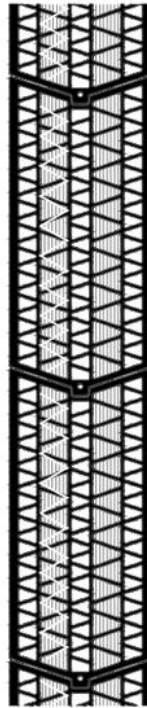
Sección constructiva del muro diseñado. Elaboración del autor.
